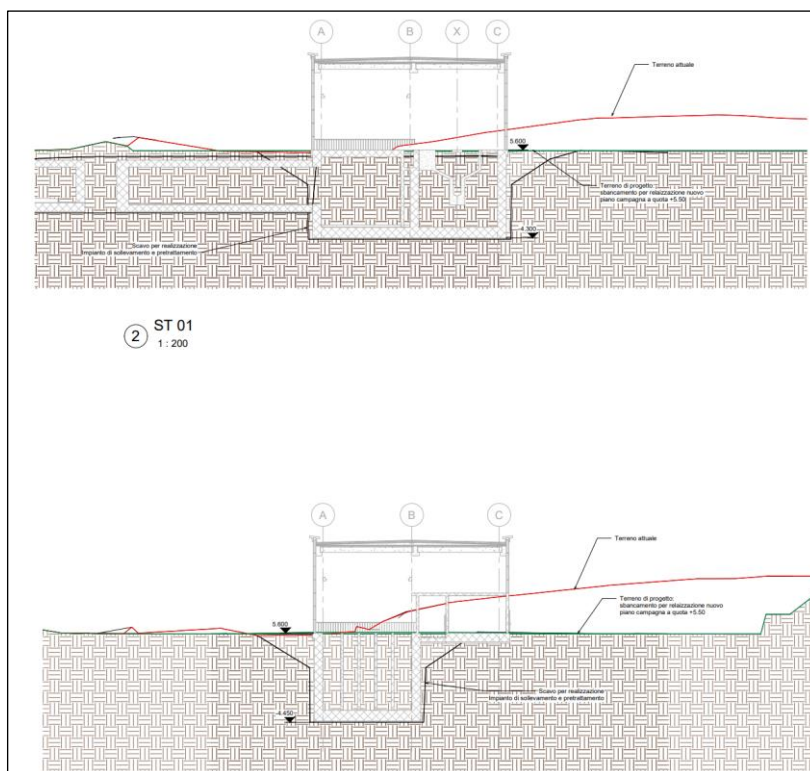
Sezioni di progetto impianto sollevamento e pretrattamento
